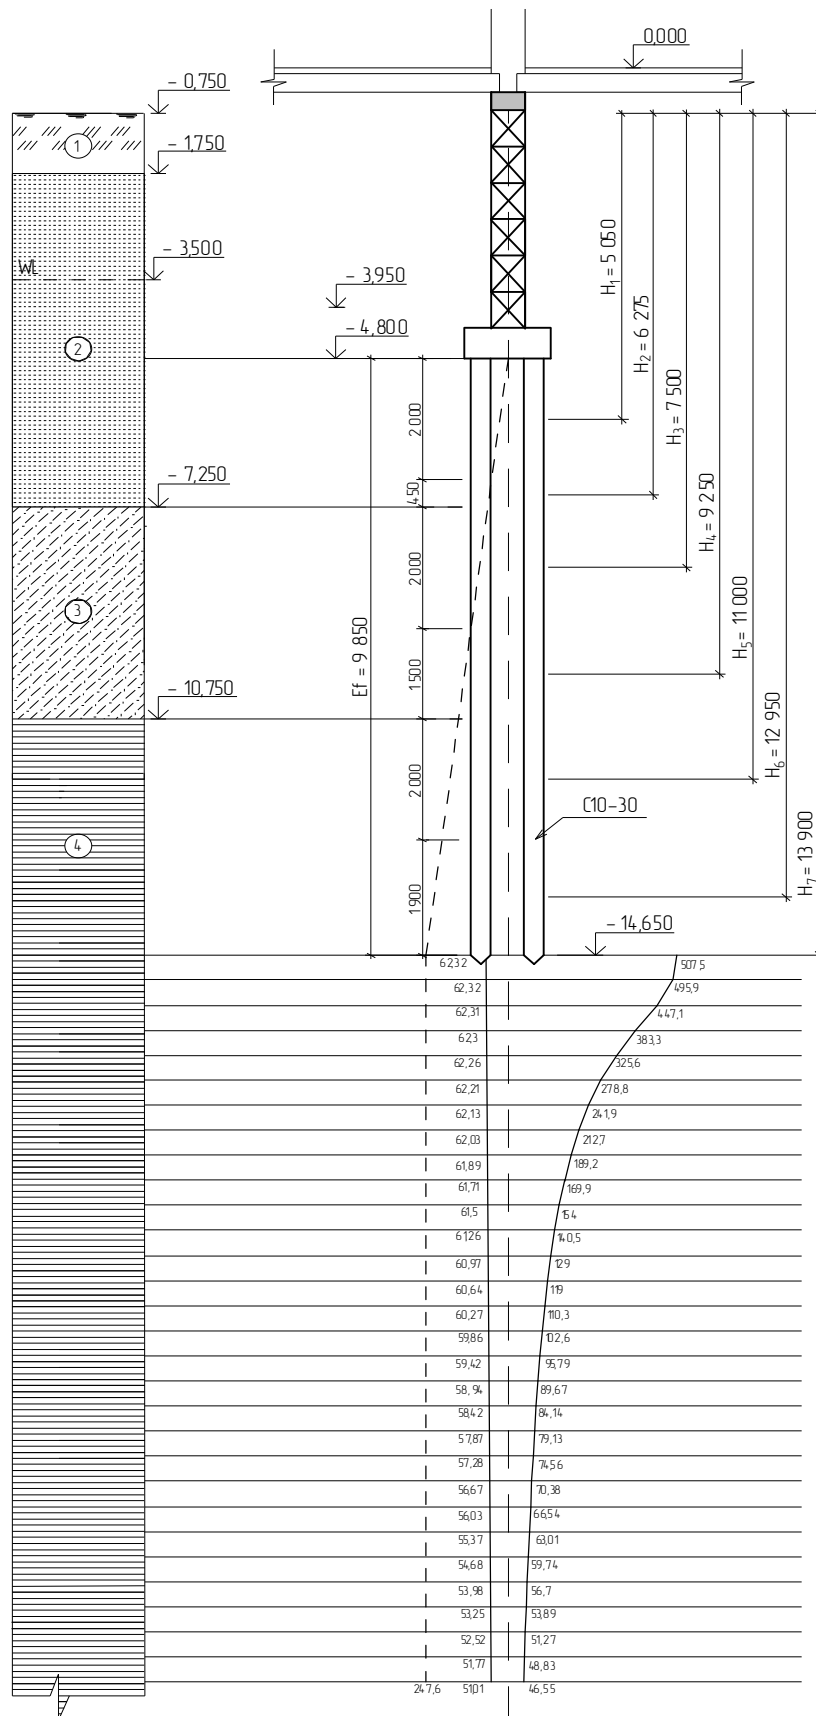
Розрахункова схема для визначення осідання пального фундаменту
